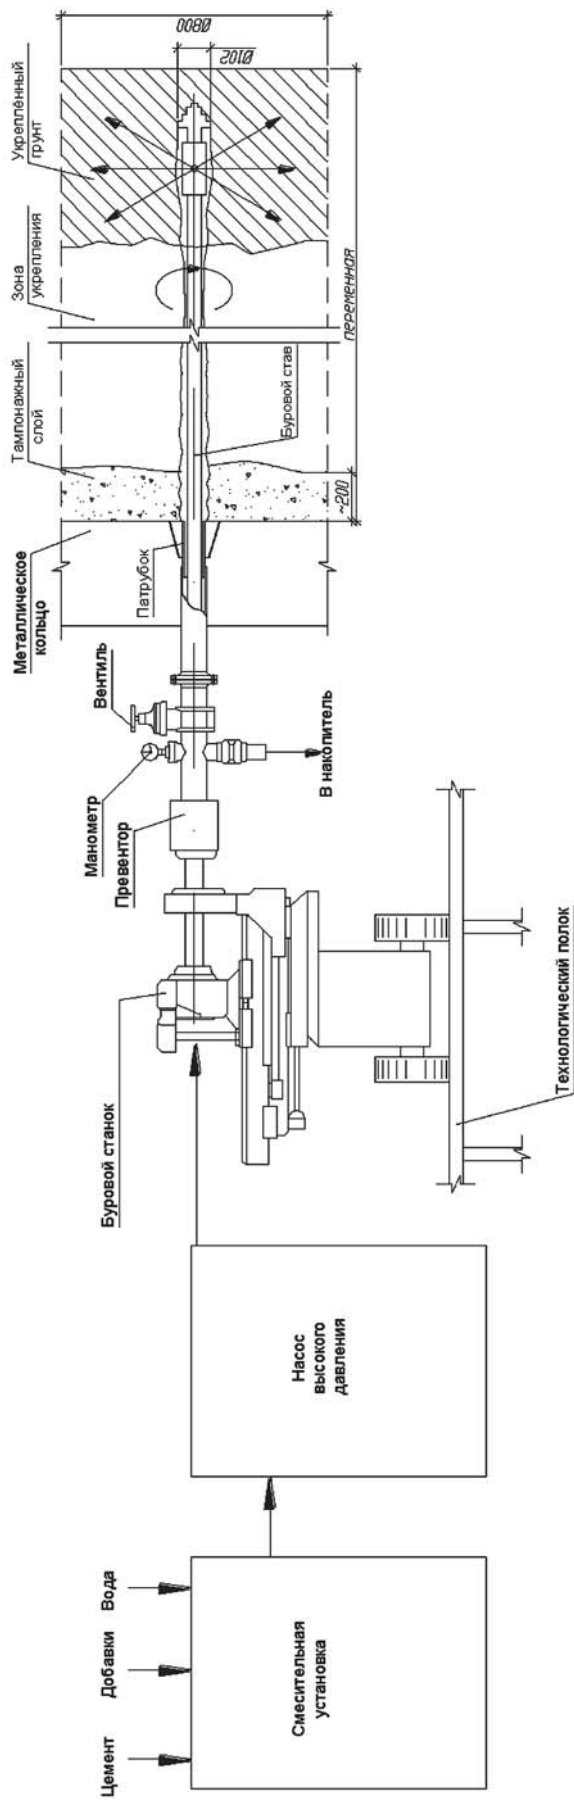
Технологическая схема укрепления грунтов горизонтальными грунтоцементными сваями
